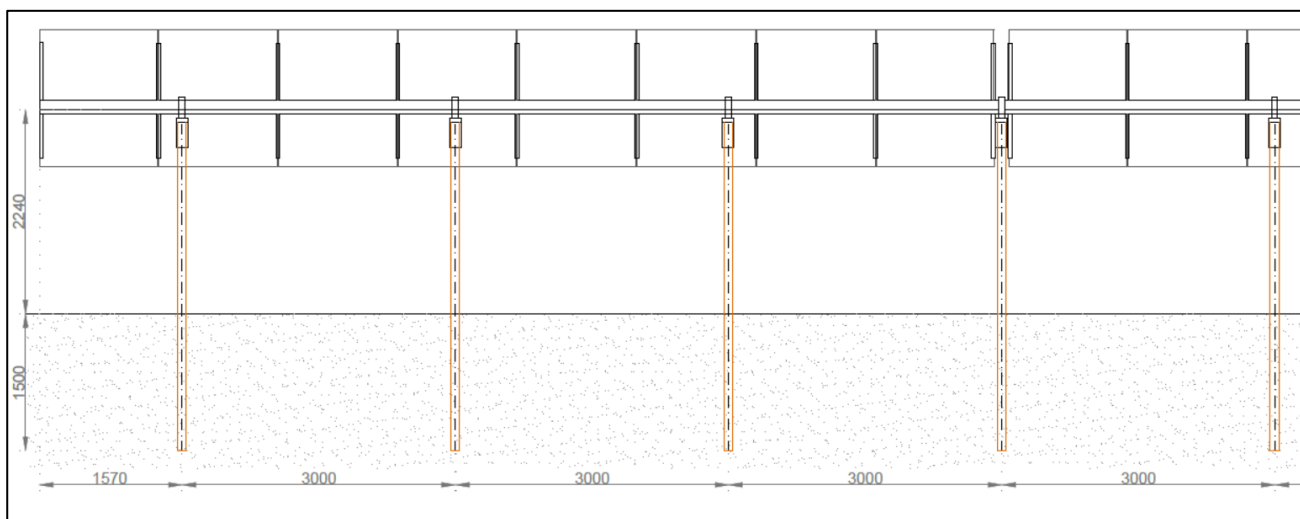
stralcio prospetto struttura di supporto 1x15P-15
